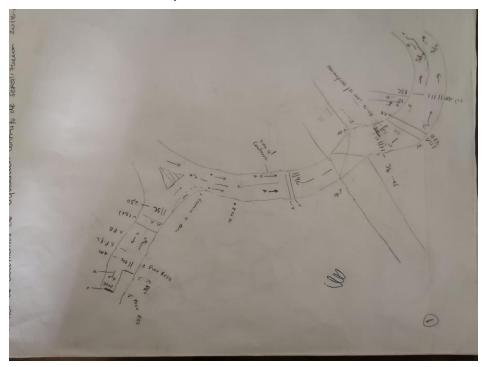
Levantamiento de la Calle 40 Entre Cr 105 y 108 en San Javier
